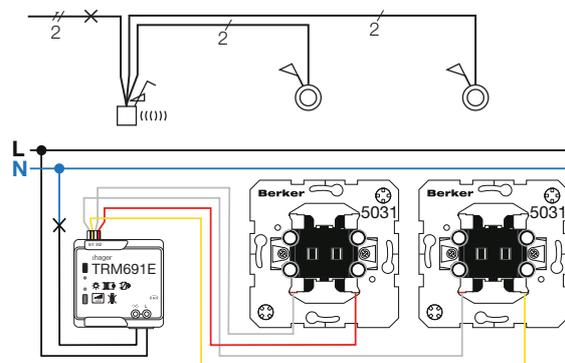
Dimmen einer Lampe, Binäreingänge mit Tastern
